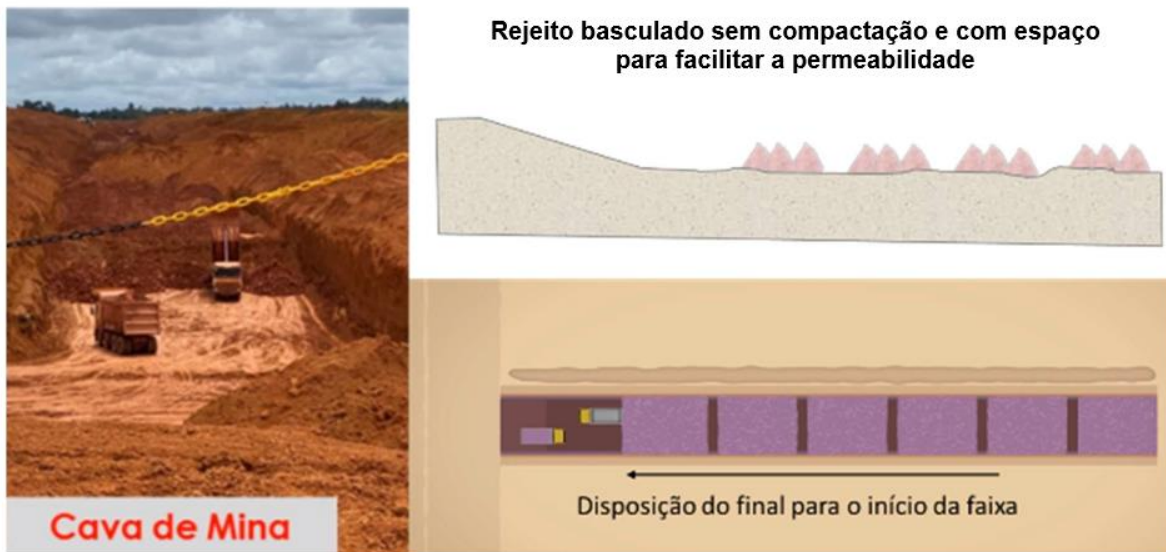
Ilustração esquemática da disposição de rejeito em fundo de cava.
